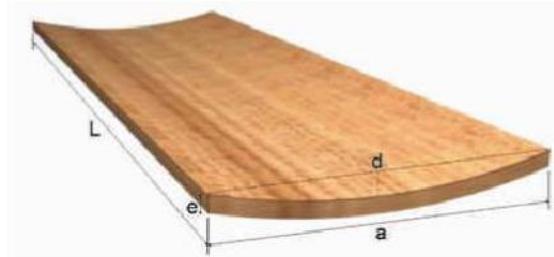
Alabeo o deformación de la madera llamada acanaladura:
